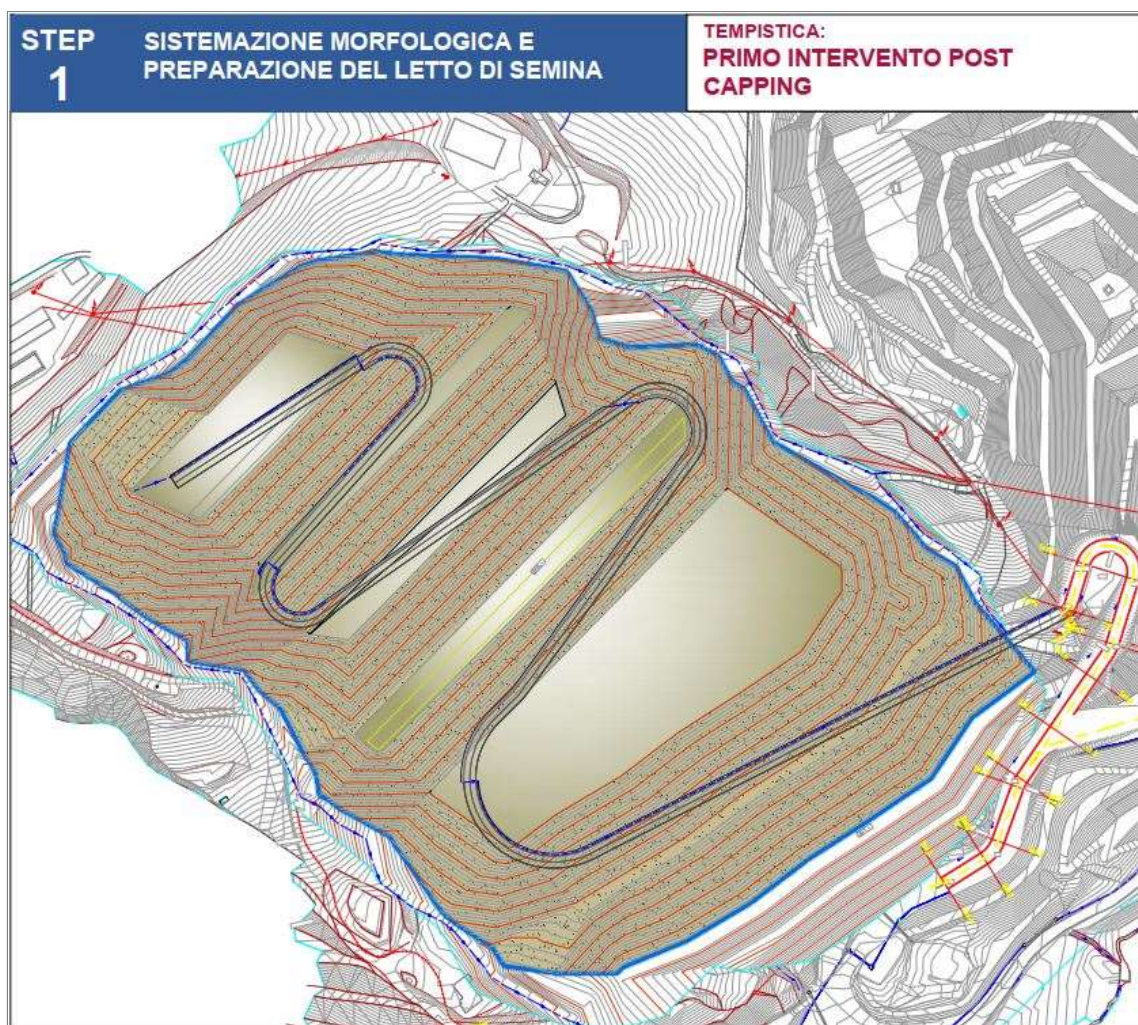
Stralcio della “Planimetria stato di progetto delle opere a verde” (elab. 2.3) con indicazione dell’area di intervento per il primo intervento post capping (sistemazione morfologica e preparazione del letto di semina).
